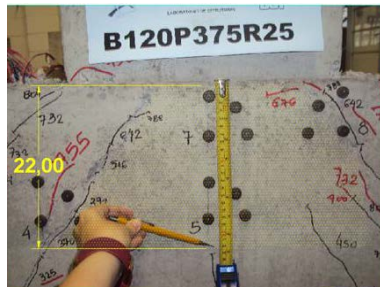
Detalhes do encontro da fissura na região da estaca - B120P375R25
